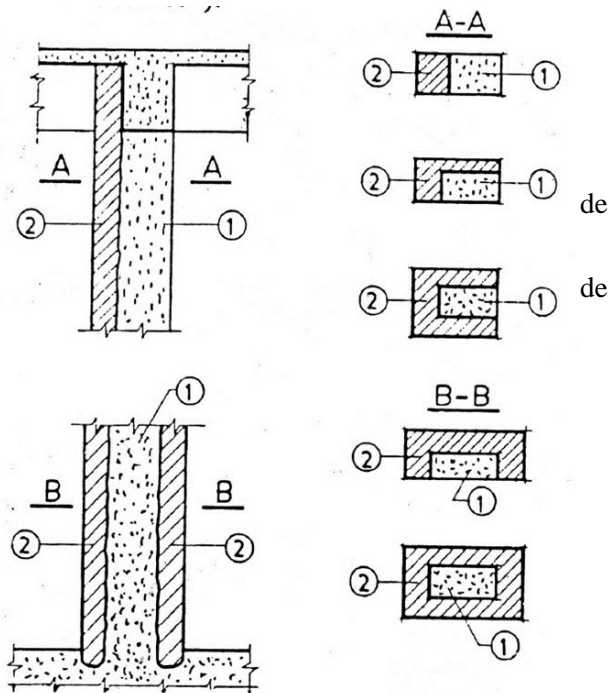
Renforcement de poteaux au moyen de profils métallique
